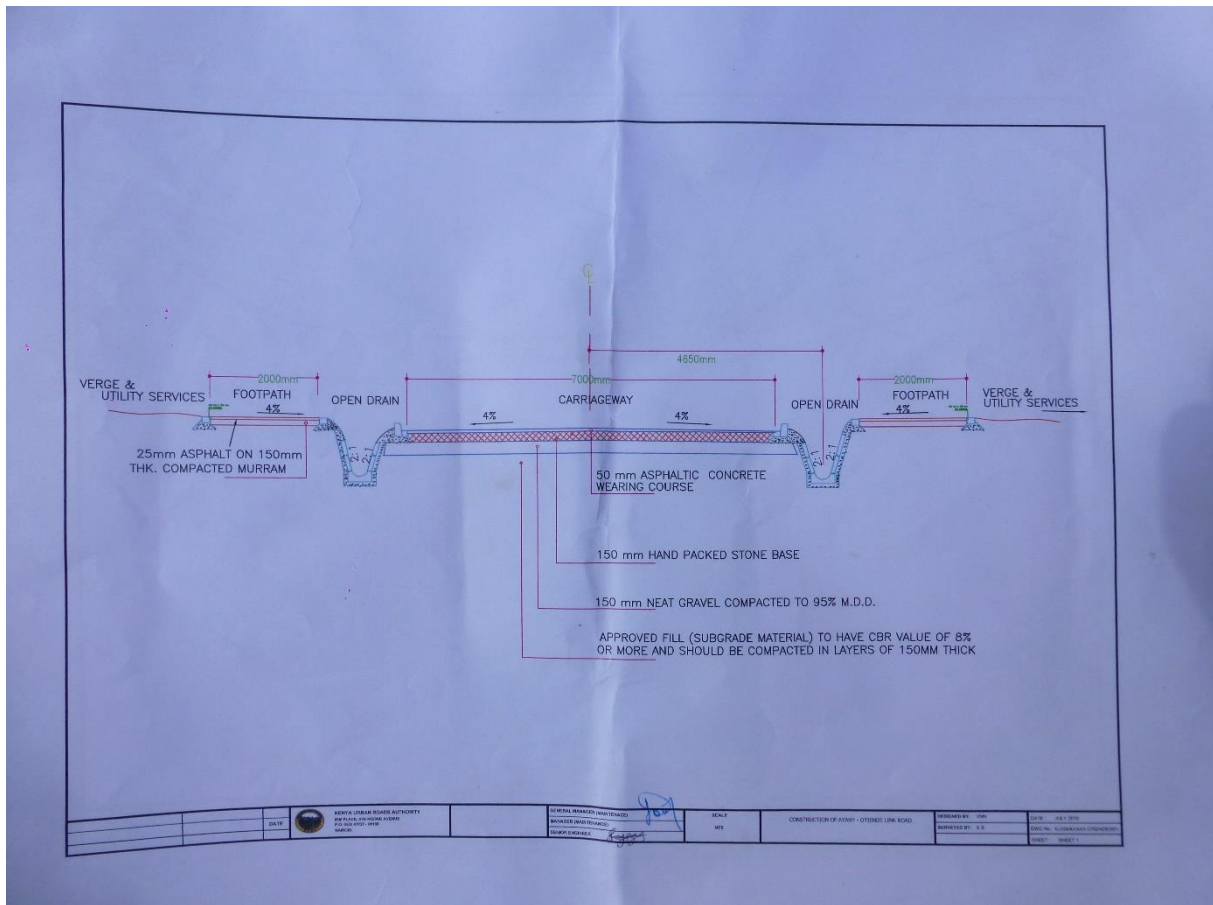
Bauplan der Otiende Ayany Link Road / Foto Autorin 2016
